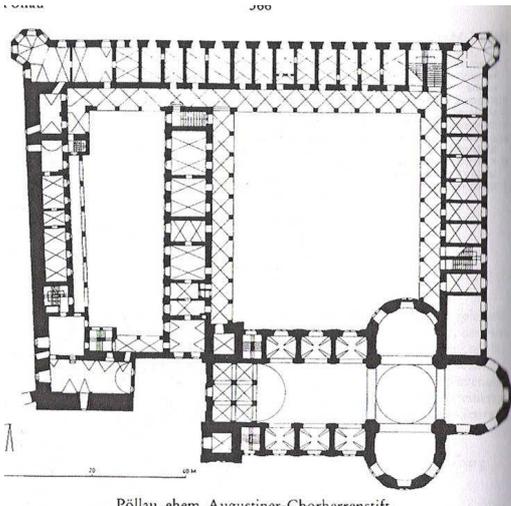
Grundriss des Stiftes Pöllau
